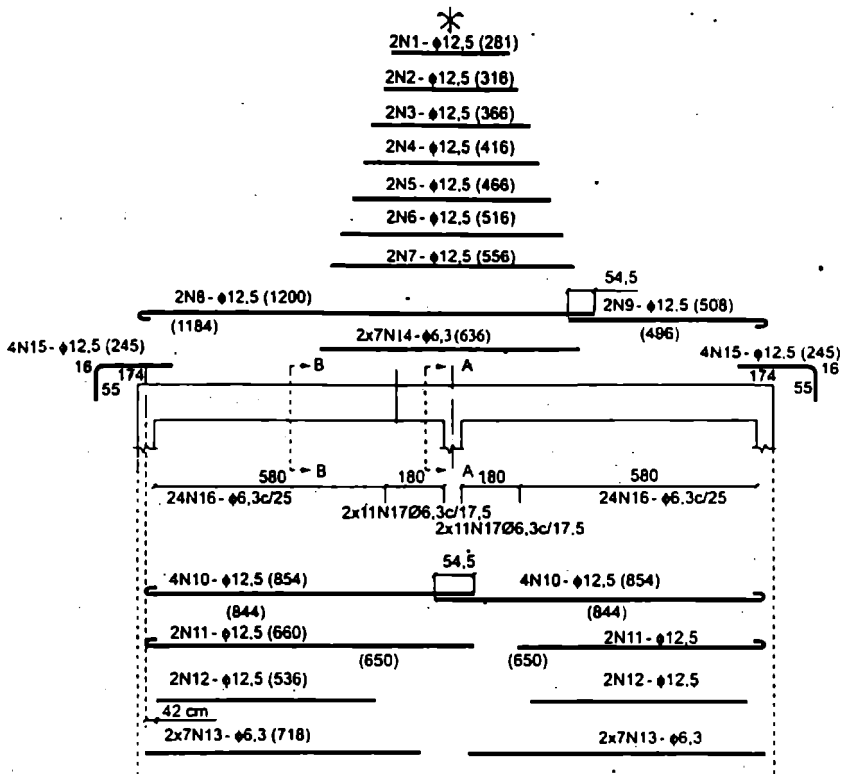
Armadura longitudinal ao longo da viga e estribos (medidas em cm).
